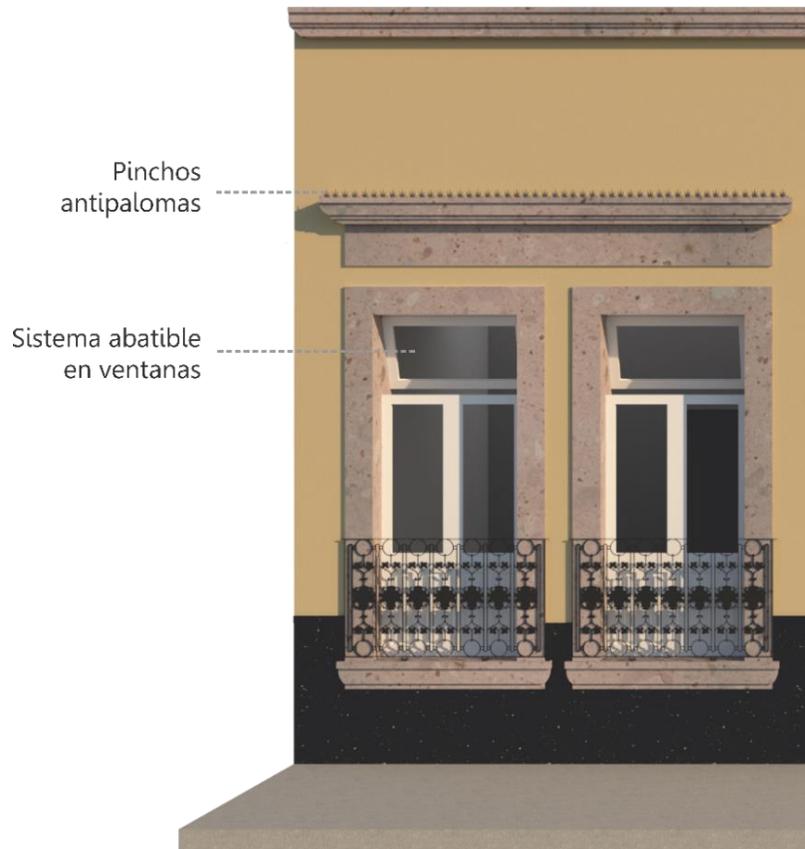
Detalle de fachada con vista a ventanas donde se aprecian pinchos antipalomas y sistema abatible de ventanas.
